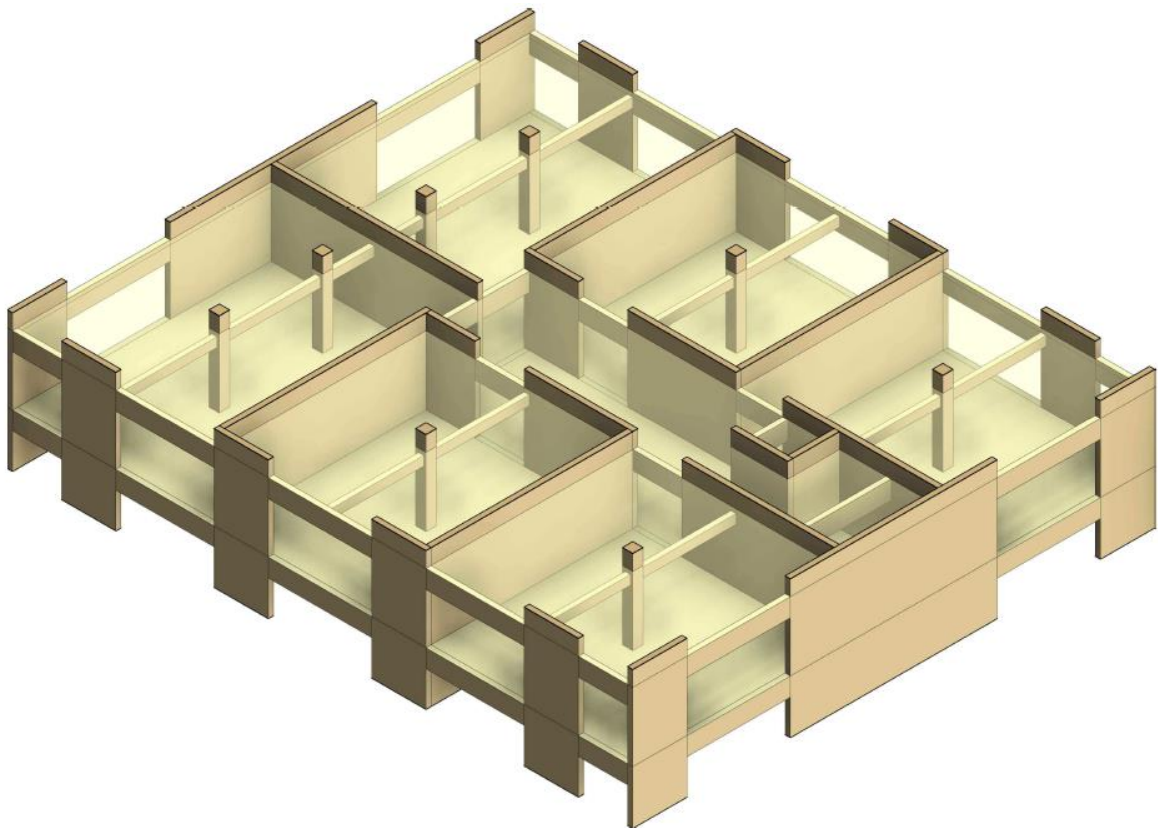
Principe constructif du système de panneau porteurs et contreventant [1]
